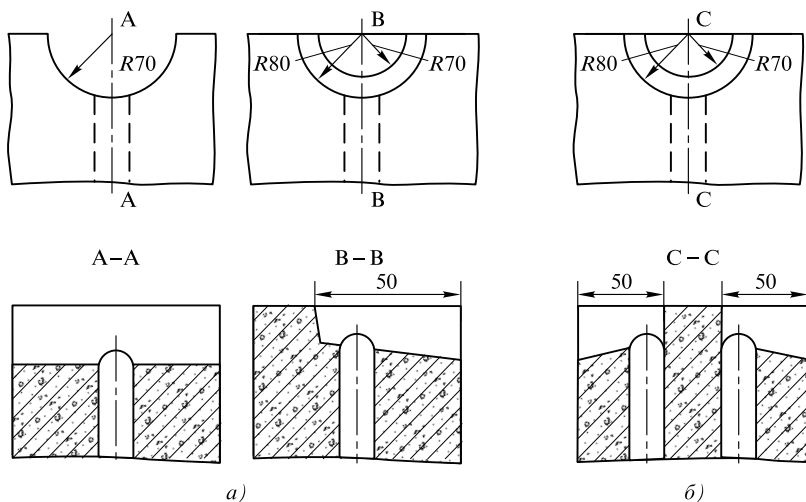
Протяжные ниши в межкомнатных (а) и межквартирных (б) стеновых железобетонных панелях
